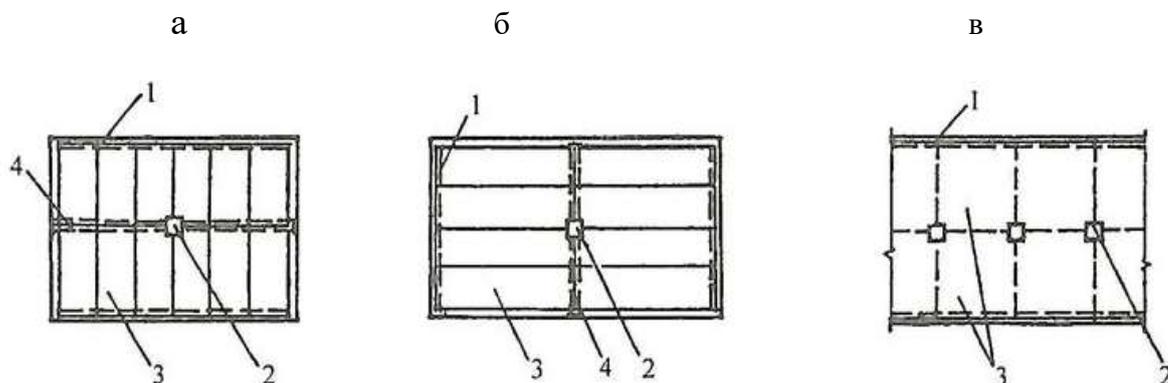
Здания с неполным каркасом: а — с продольным расположением ригелей; б — с поперечным расположением ригелей; в — безригельное решение; 1 — несущие и наружные стены; 2 — колонны внутреннего каркаса; 3 — 3 плиты перекрытия; 4 — ригели
